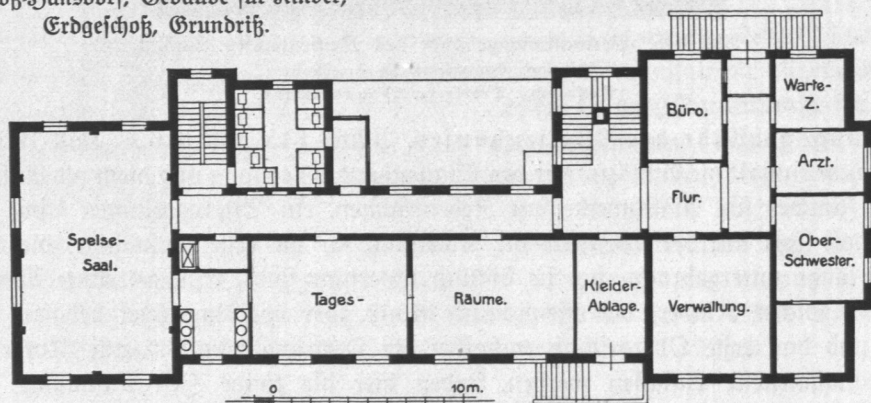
Genesungs- und Erholungsheim Groß-Hansdorf, Gebäude für Frauen, Erdgeschoss, Grundriß.
